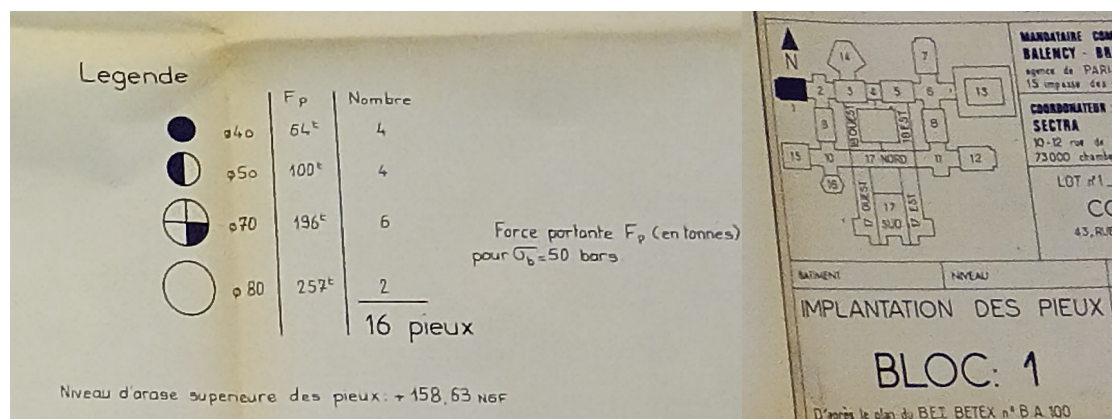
Localisation du pieux reconnu au droit de la fouille F7 sur le bloc 1
